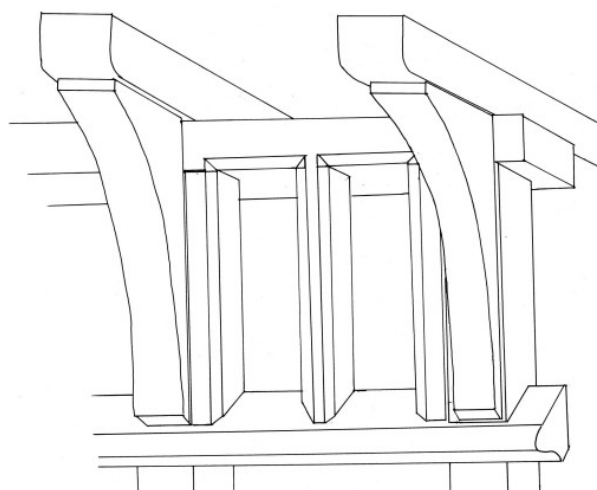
Fensteröffnung mit Knaggen und profiliertem Brüstungsriegel.
